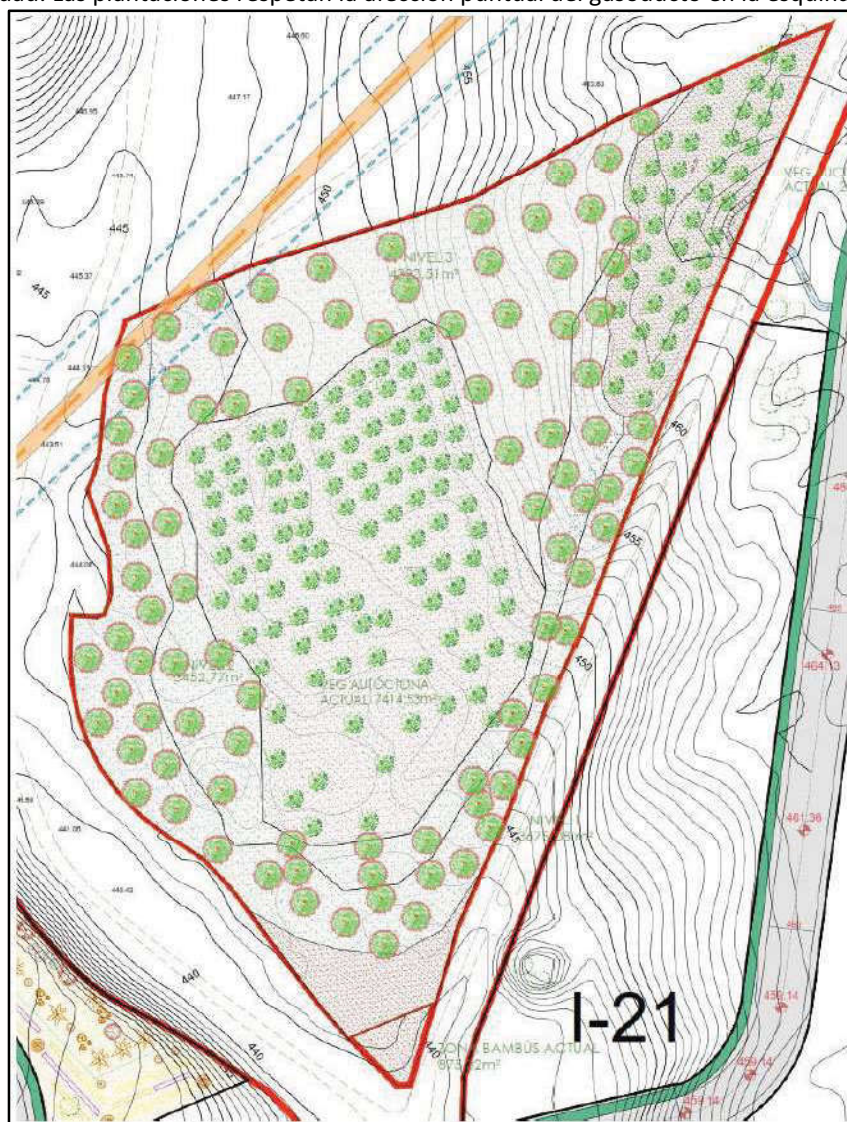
Proyecto en el ámbito de la DC-03 REFORESTACIÓN.
